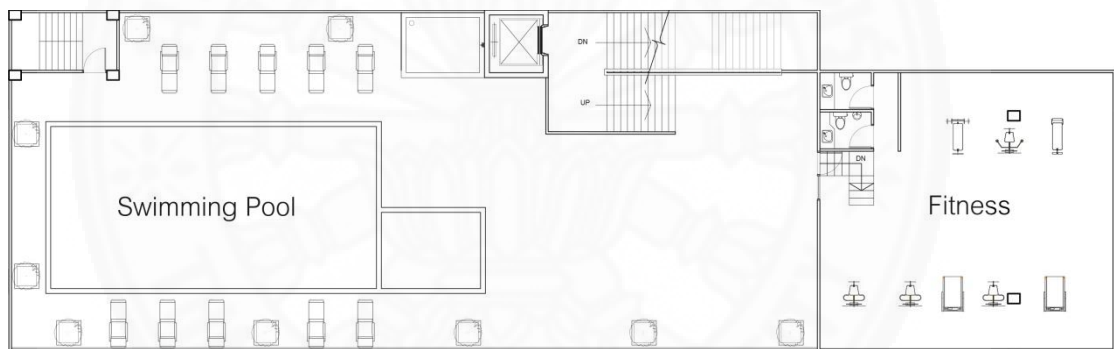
แสดงผังชั้นที่ 1 โครงการ Q
